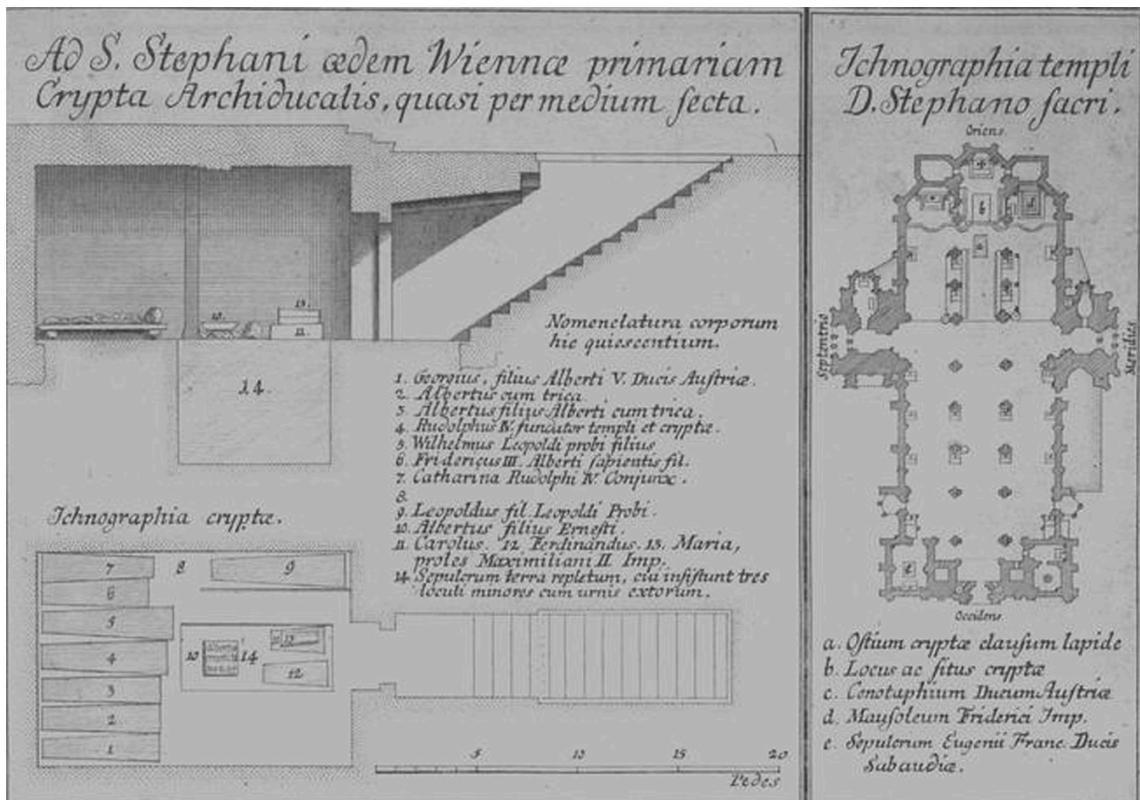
Salomon Kleiner, Grundrisse und Aufriss, Herzogsgruft, St. Stephan, Wien, 1772, Stich.
